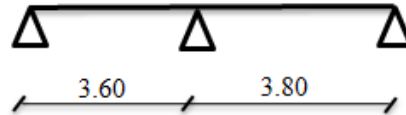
Poutrelle type 04 (Plancher Sous-Sol -usage commerciale-)
